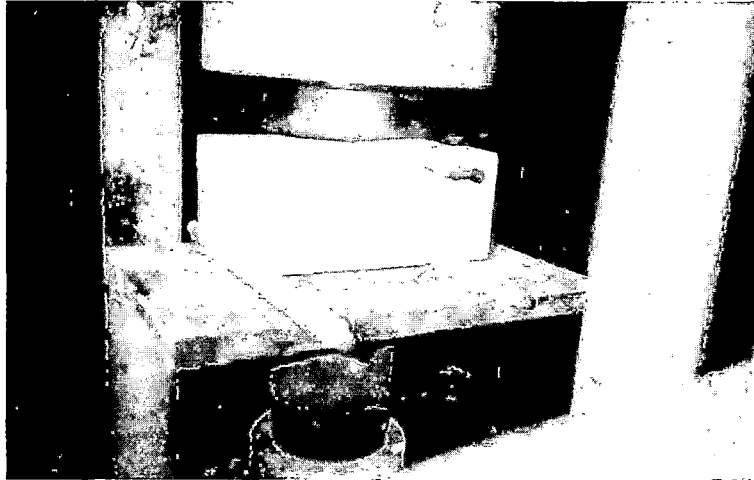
ENSAYO FLEXION O MODULO DE RUPTURA, CON CARGA CENTRAL.
